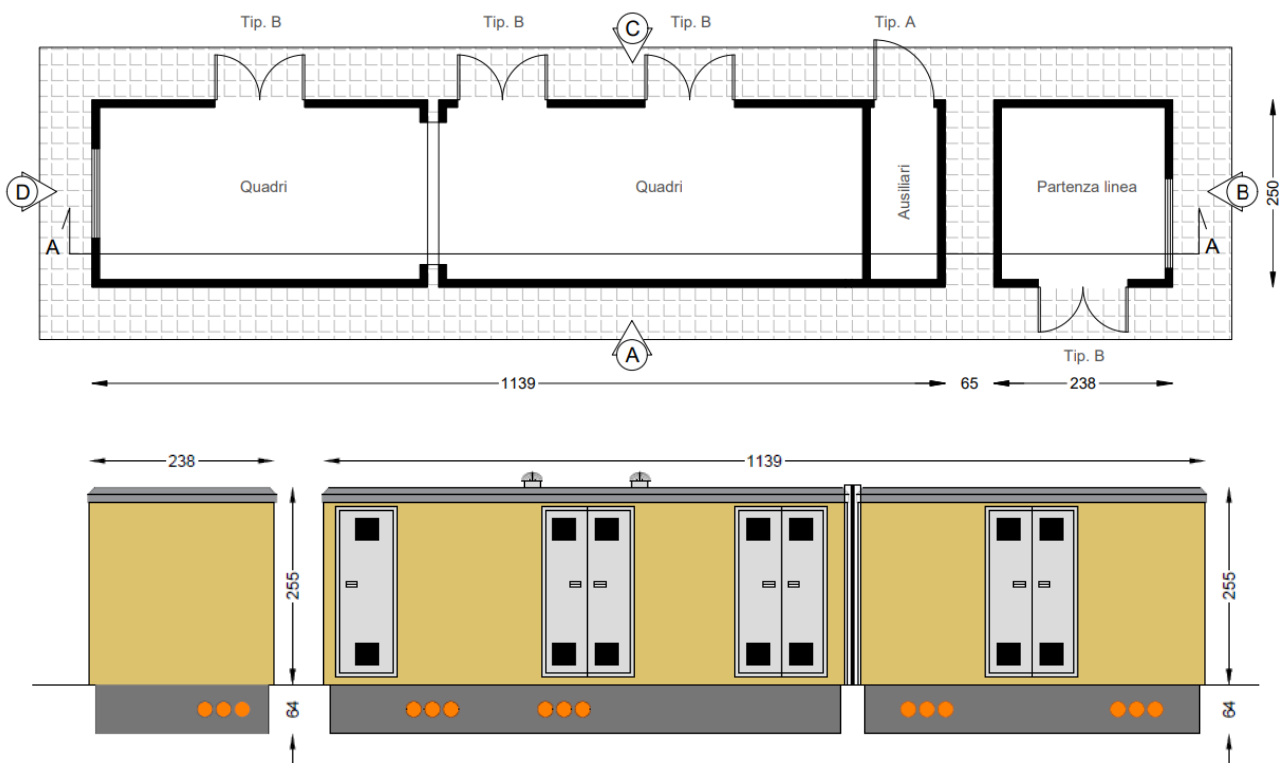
Pianta e prospetto della cabina MTR, misure in cm
